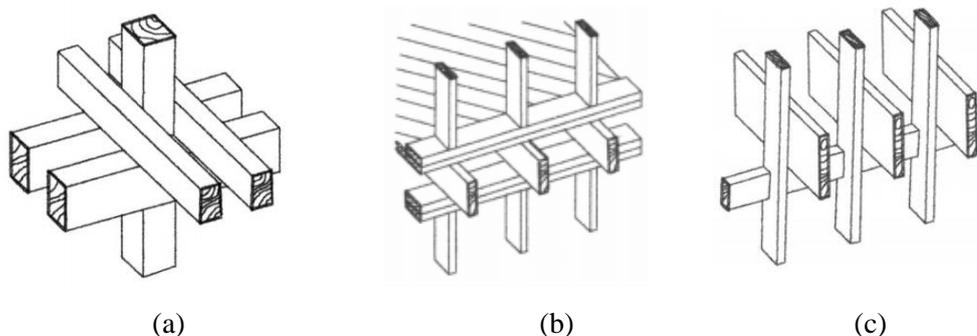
Sistemas de ligações da madeira: a) viga-pilar; b) plataforma e c) balloon frame. (Fonte: Berriel, 2009).
